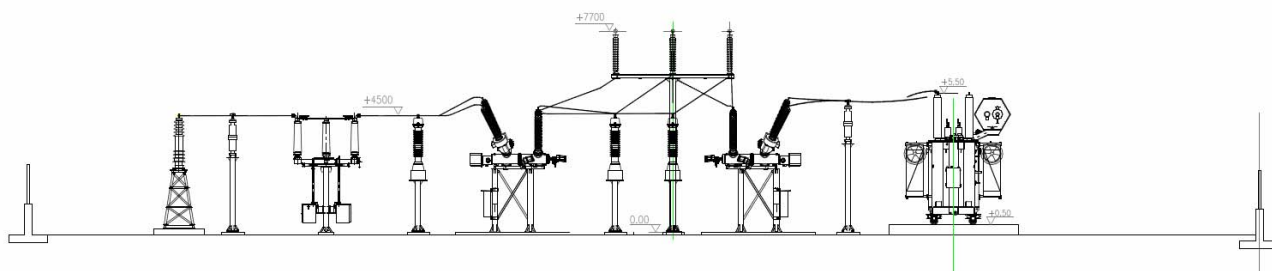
Prospetto della stazione di raccolta e trasformazione
